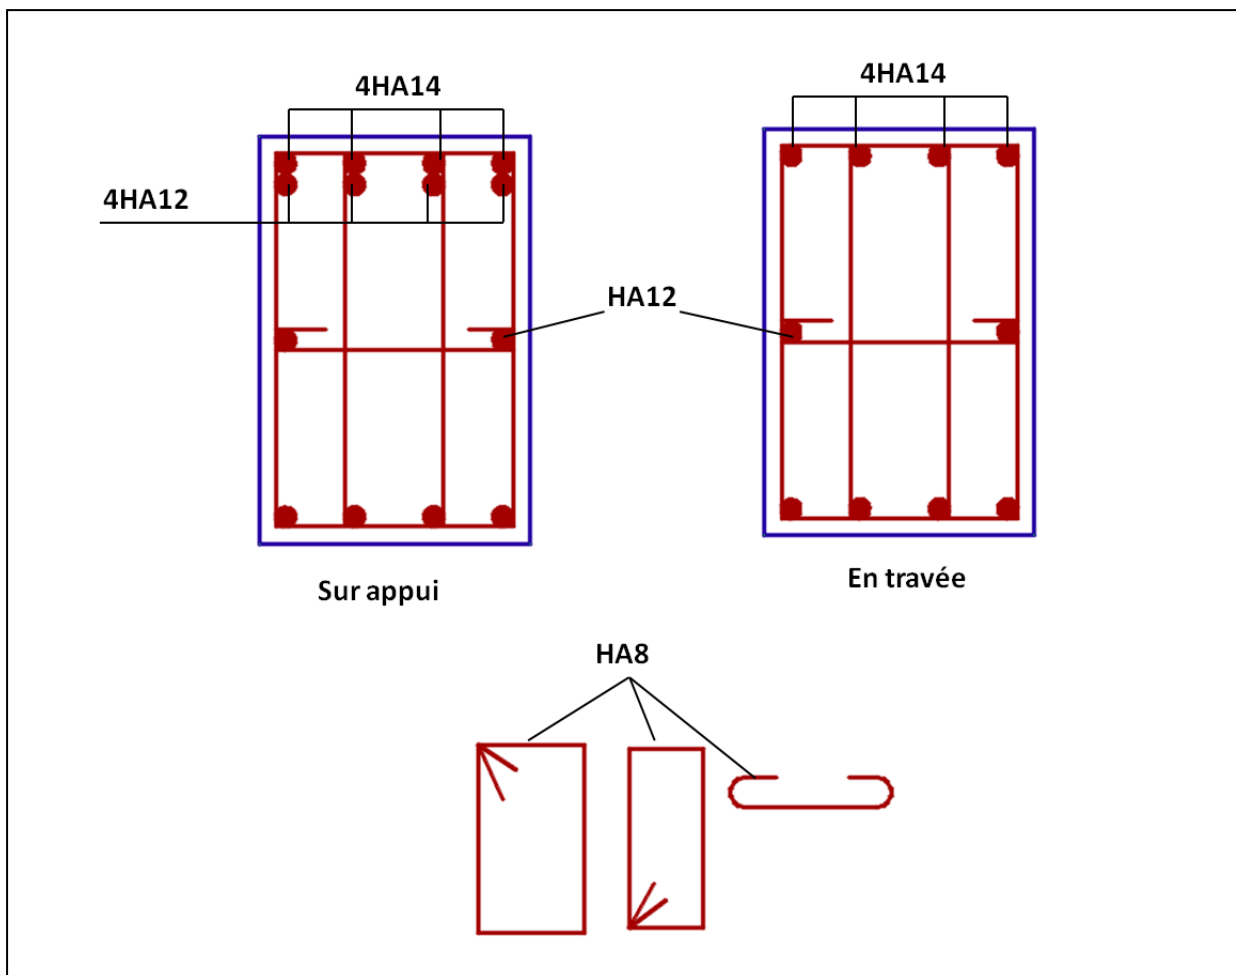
Schéma de ferrailage d'une poutre longitudinale
